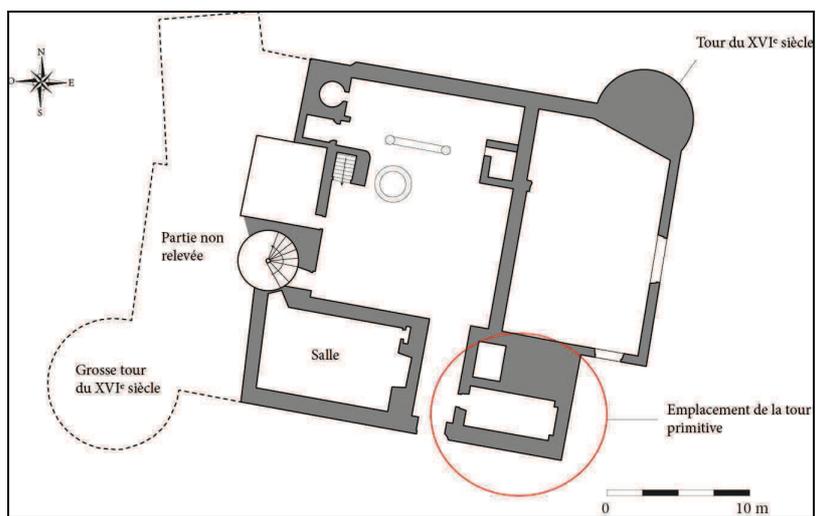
Plan du château de Perricard. DAO : F. Boisserie.
